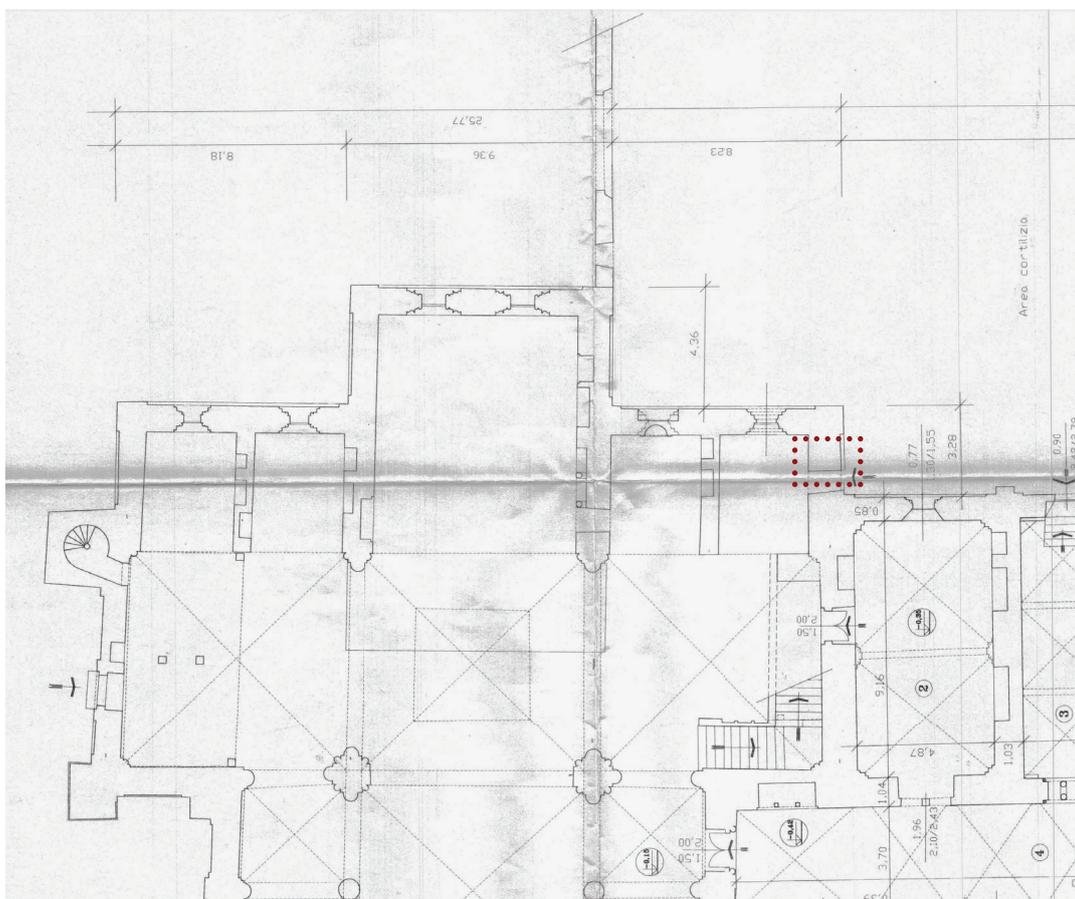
Studio Tecnico Elli Sala, stralcio della planimetria della chiesa con l'individuazione dell'apertura di collegamento con l'esterno (in Archivio Storico SABAP-TO)
